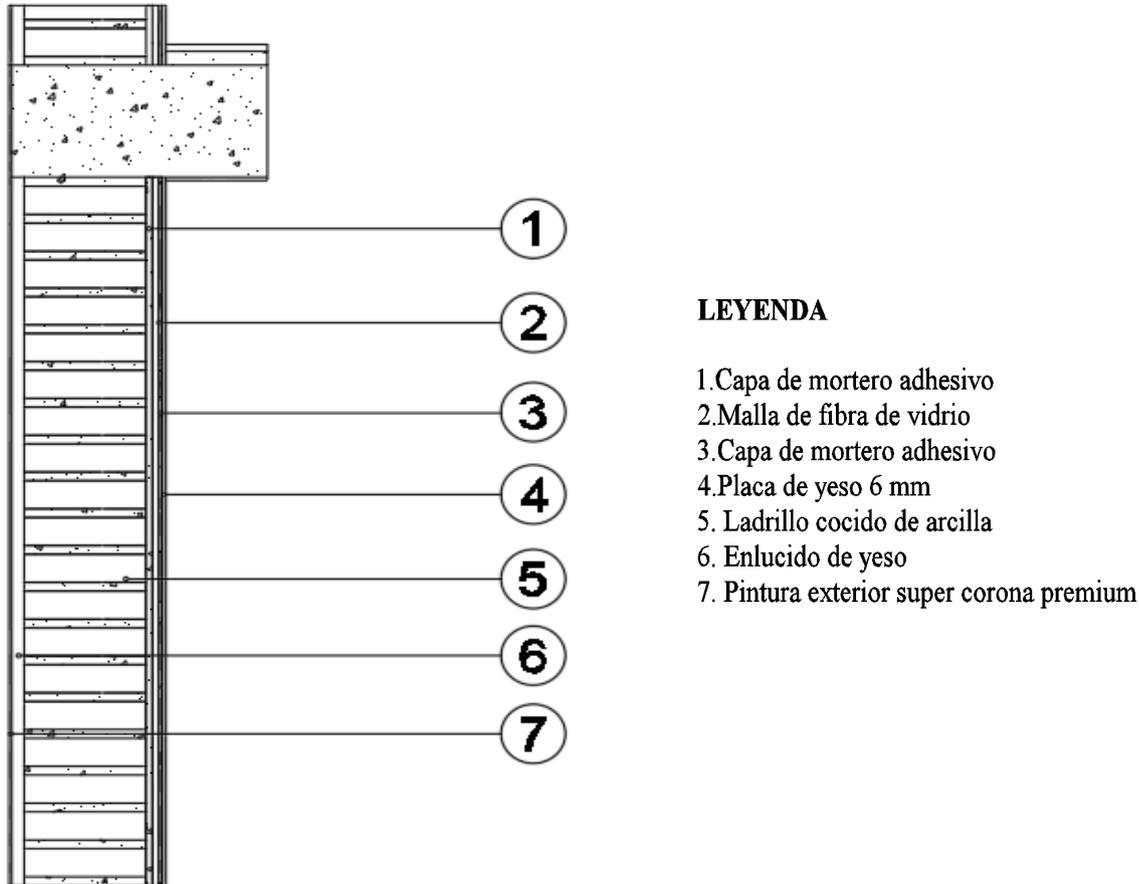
Detalle constructivo mampostería de ladrillo estado actual.
